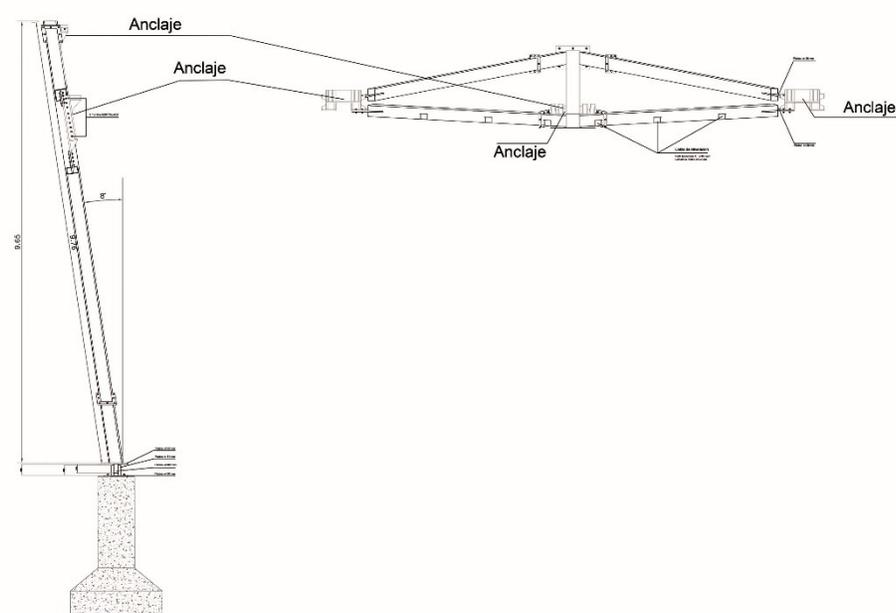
Plano de detalle de corte y fachada de la estructura de la doble fachada (Autoria, 2020)
